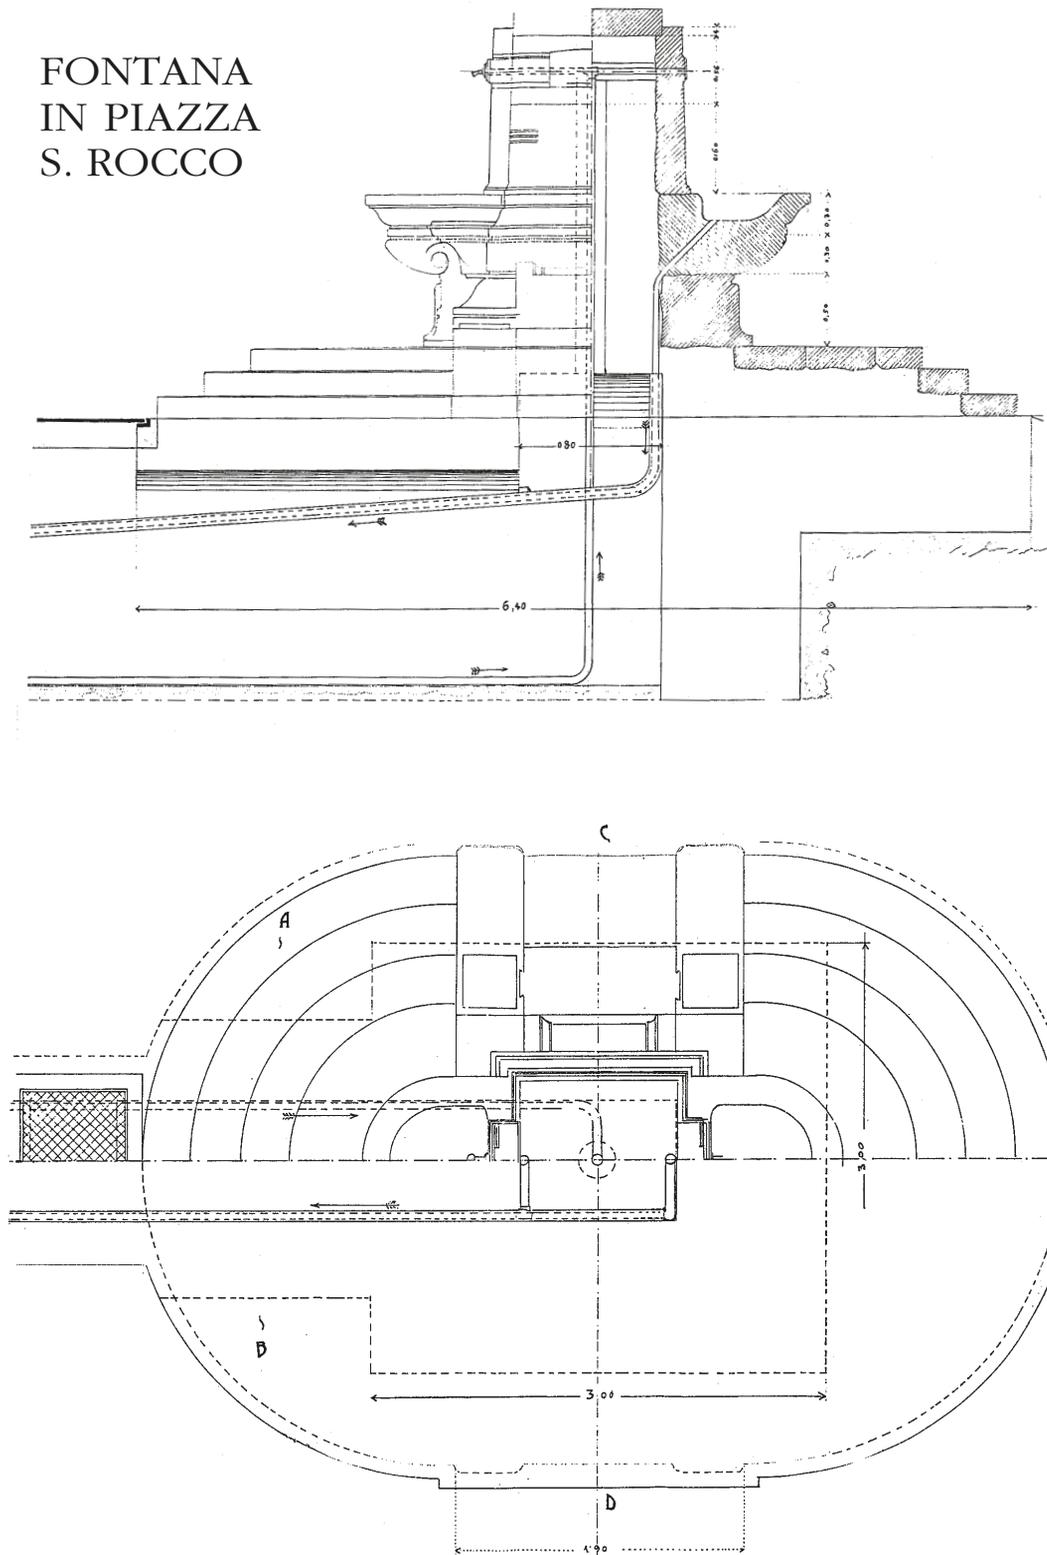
Planimetria della fontana e (sopra) sezione laterale.
